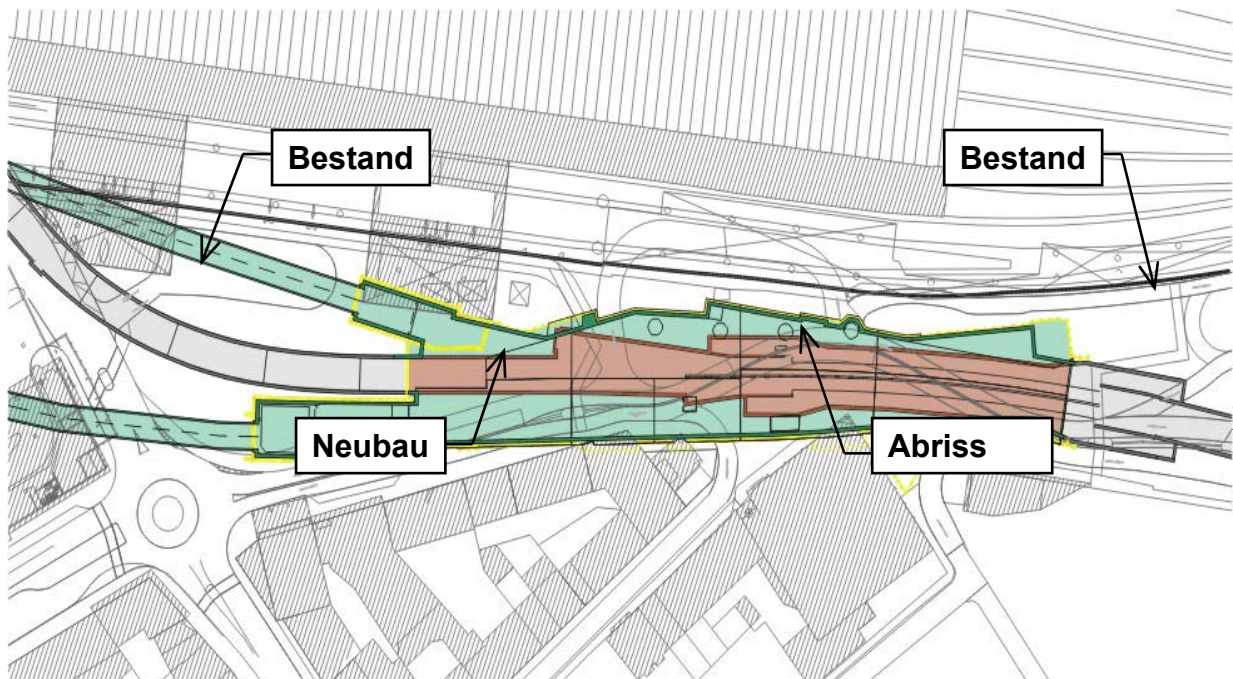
Grundriss Breslauer Platz, Bestand und Neubau
